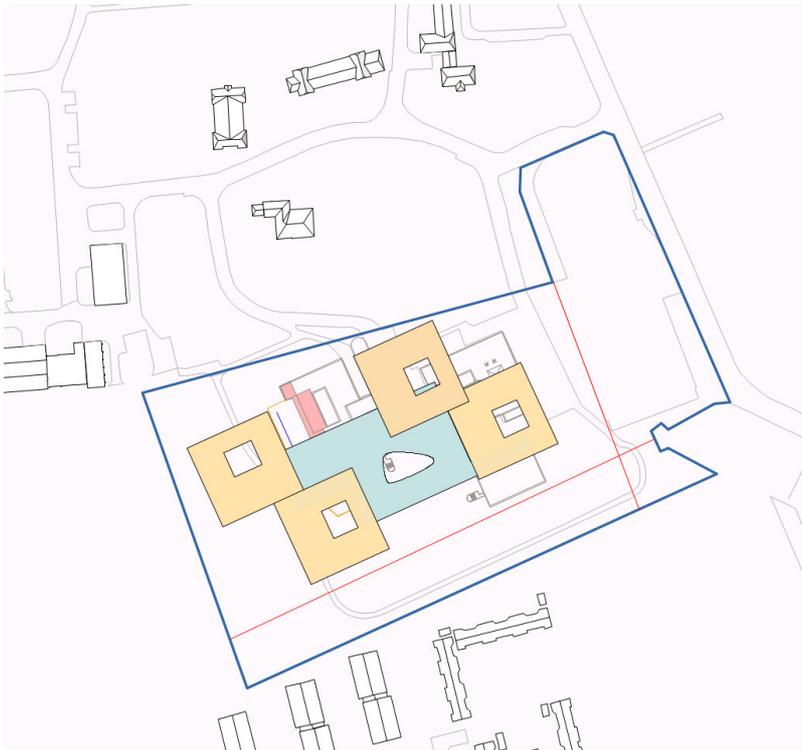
\_ Lageplan „gestapelte“ Lösung
